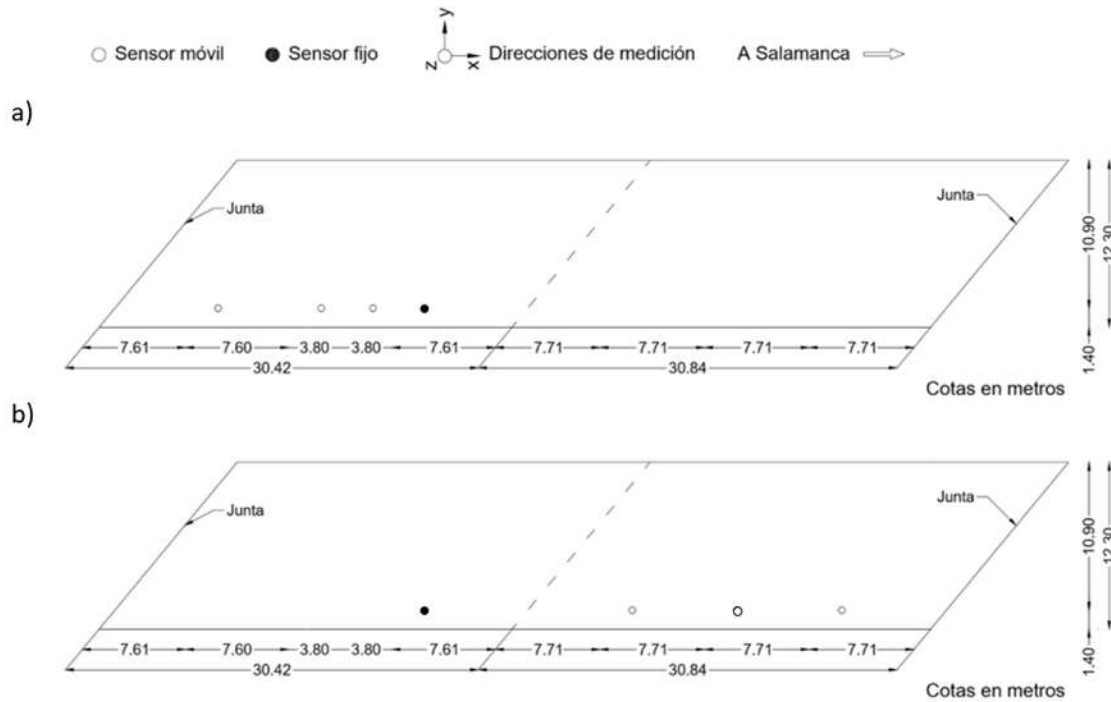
Distribución de los sensores puente Pedregal: a) primera configuración de sensores, b) segunda configuración de sensores
